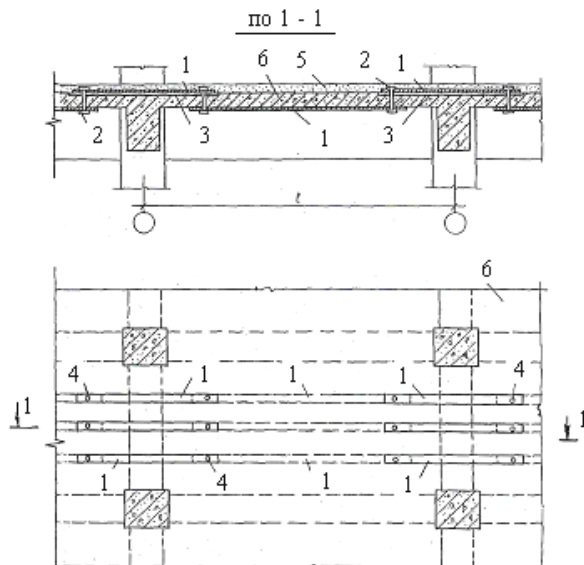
Усиление монолитных плит перекрытия с помощью металлических полос, закрепленных с двух сторон:
